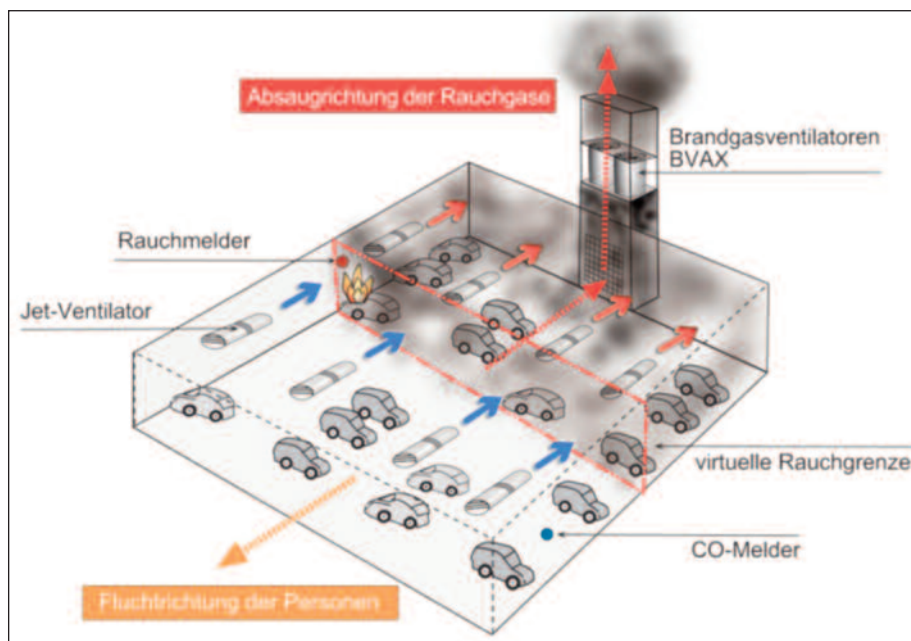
Erläuterung zum Grundprinzip einer Jet-Ventilationsanlage.
